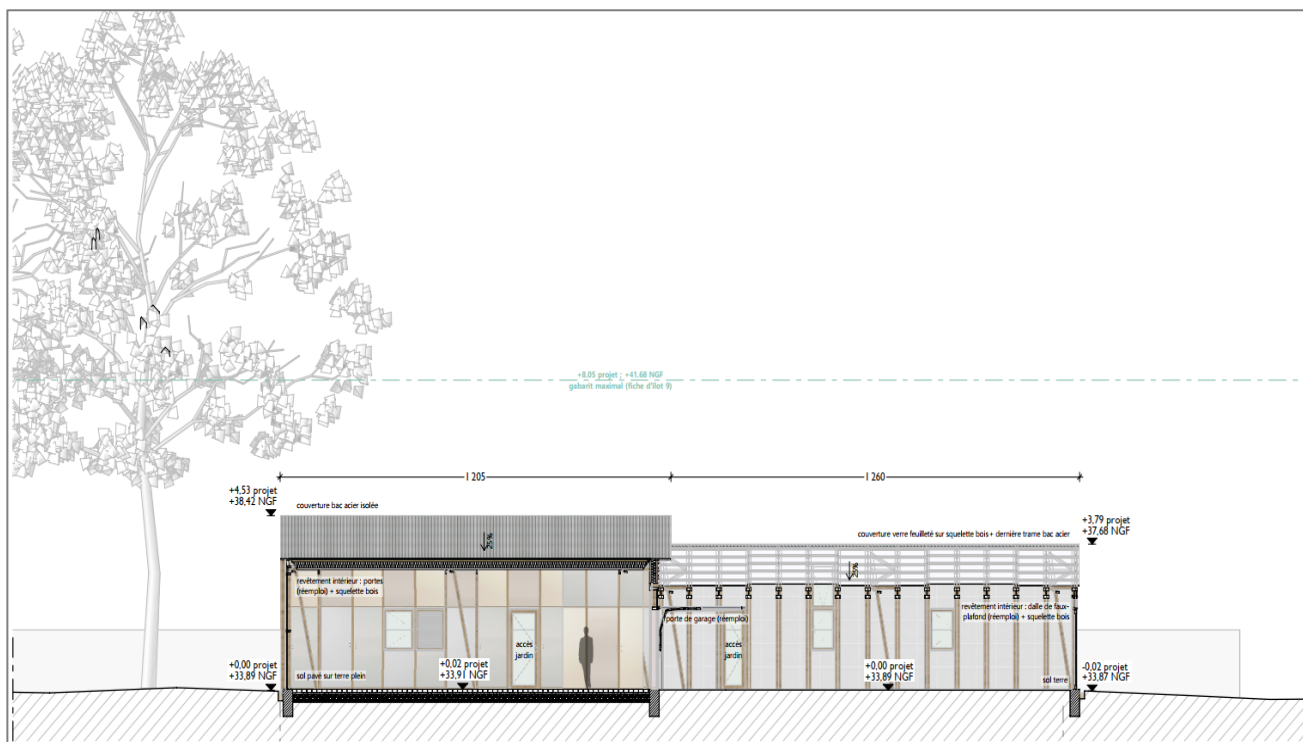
Coupe longitudinale AA' (Source : maîtrise d'œuvre)
